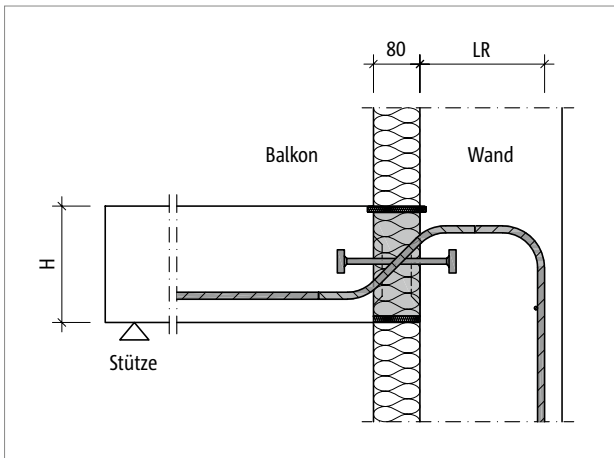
Schöck Isokorb® T Typ QP-WU: Wandanschluss nach unten bei Außendämmung
